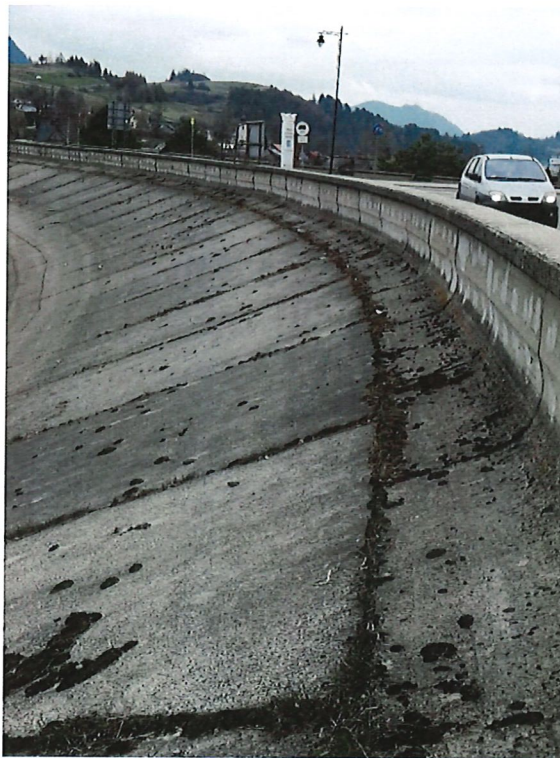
Przekrój poprzeczny falochronu (parapet od strony zbiornika).
